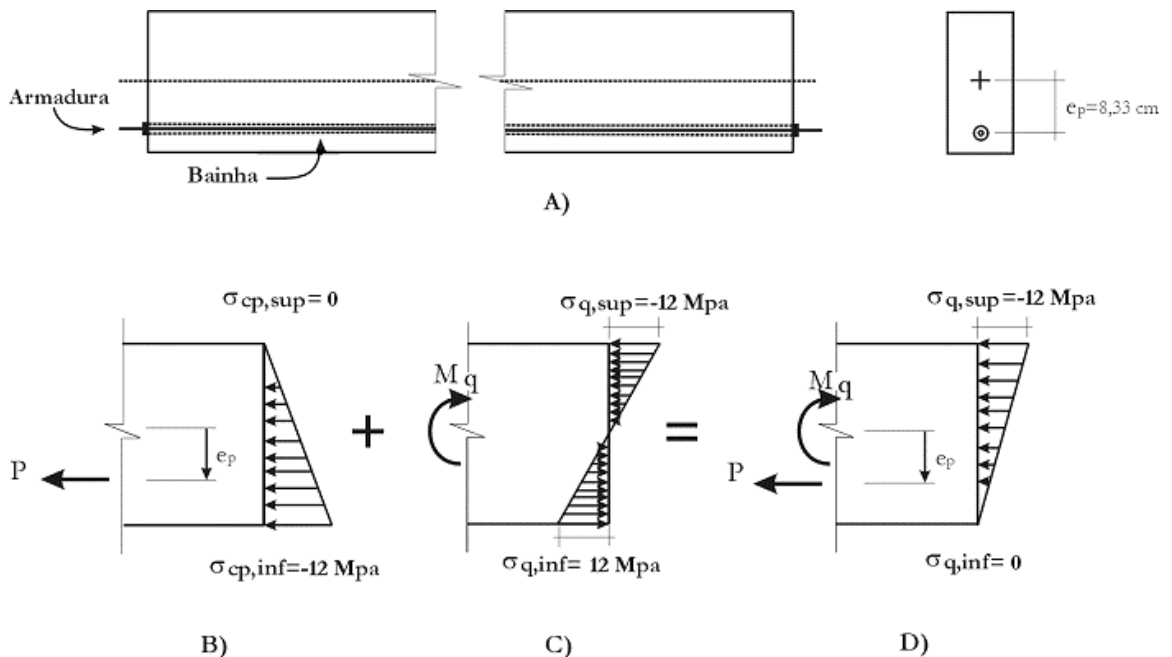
Diagrama de Tensões Normais – Viga de Concreto Protendido (Protensão Excêntrica)
